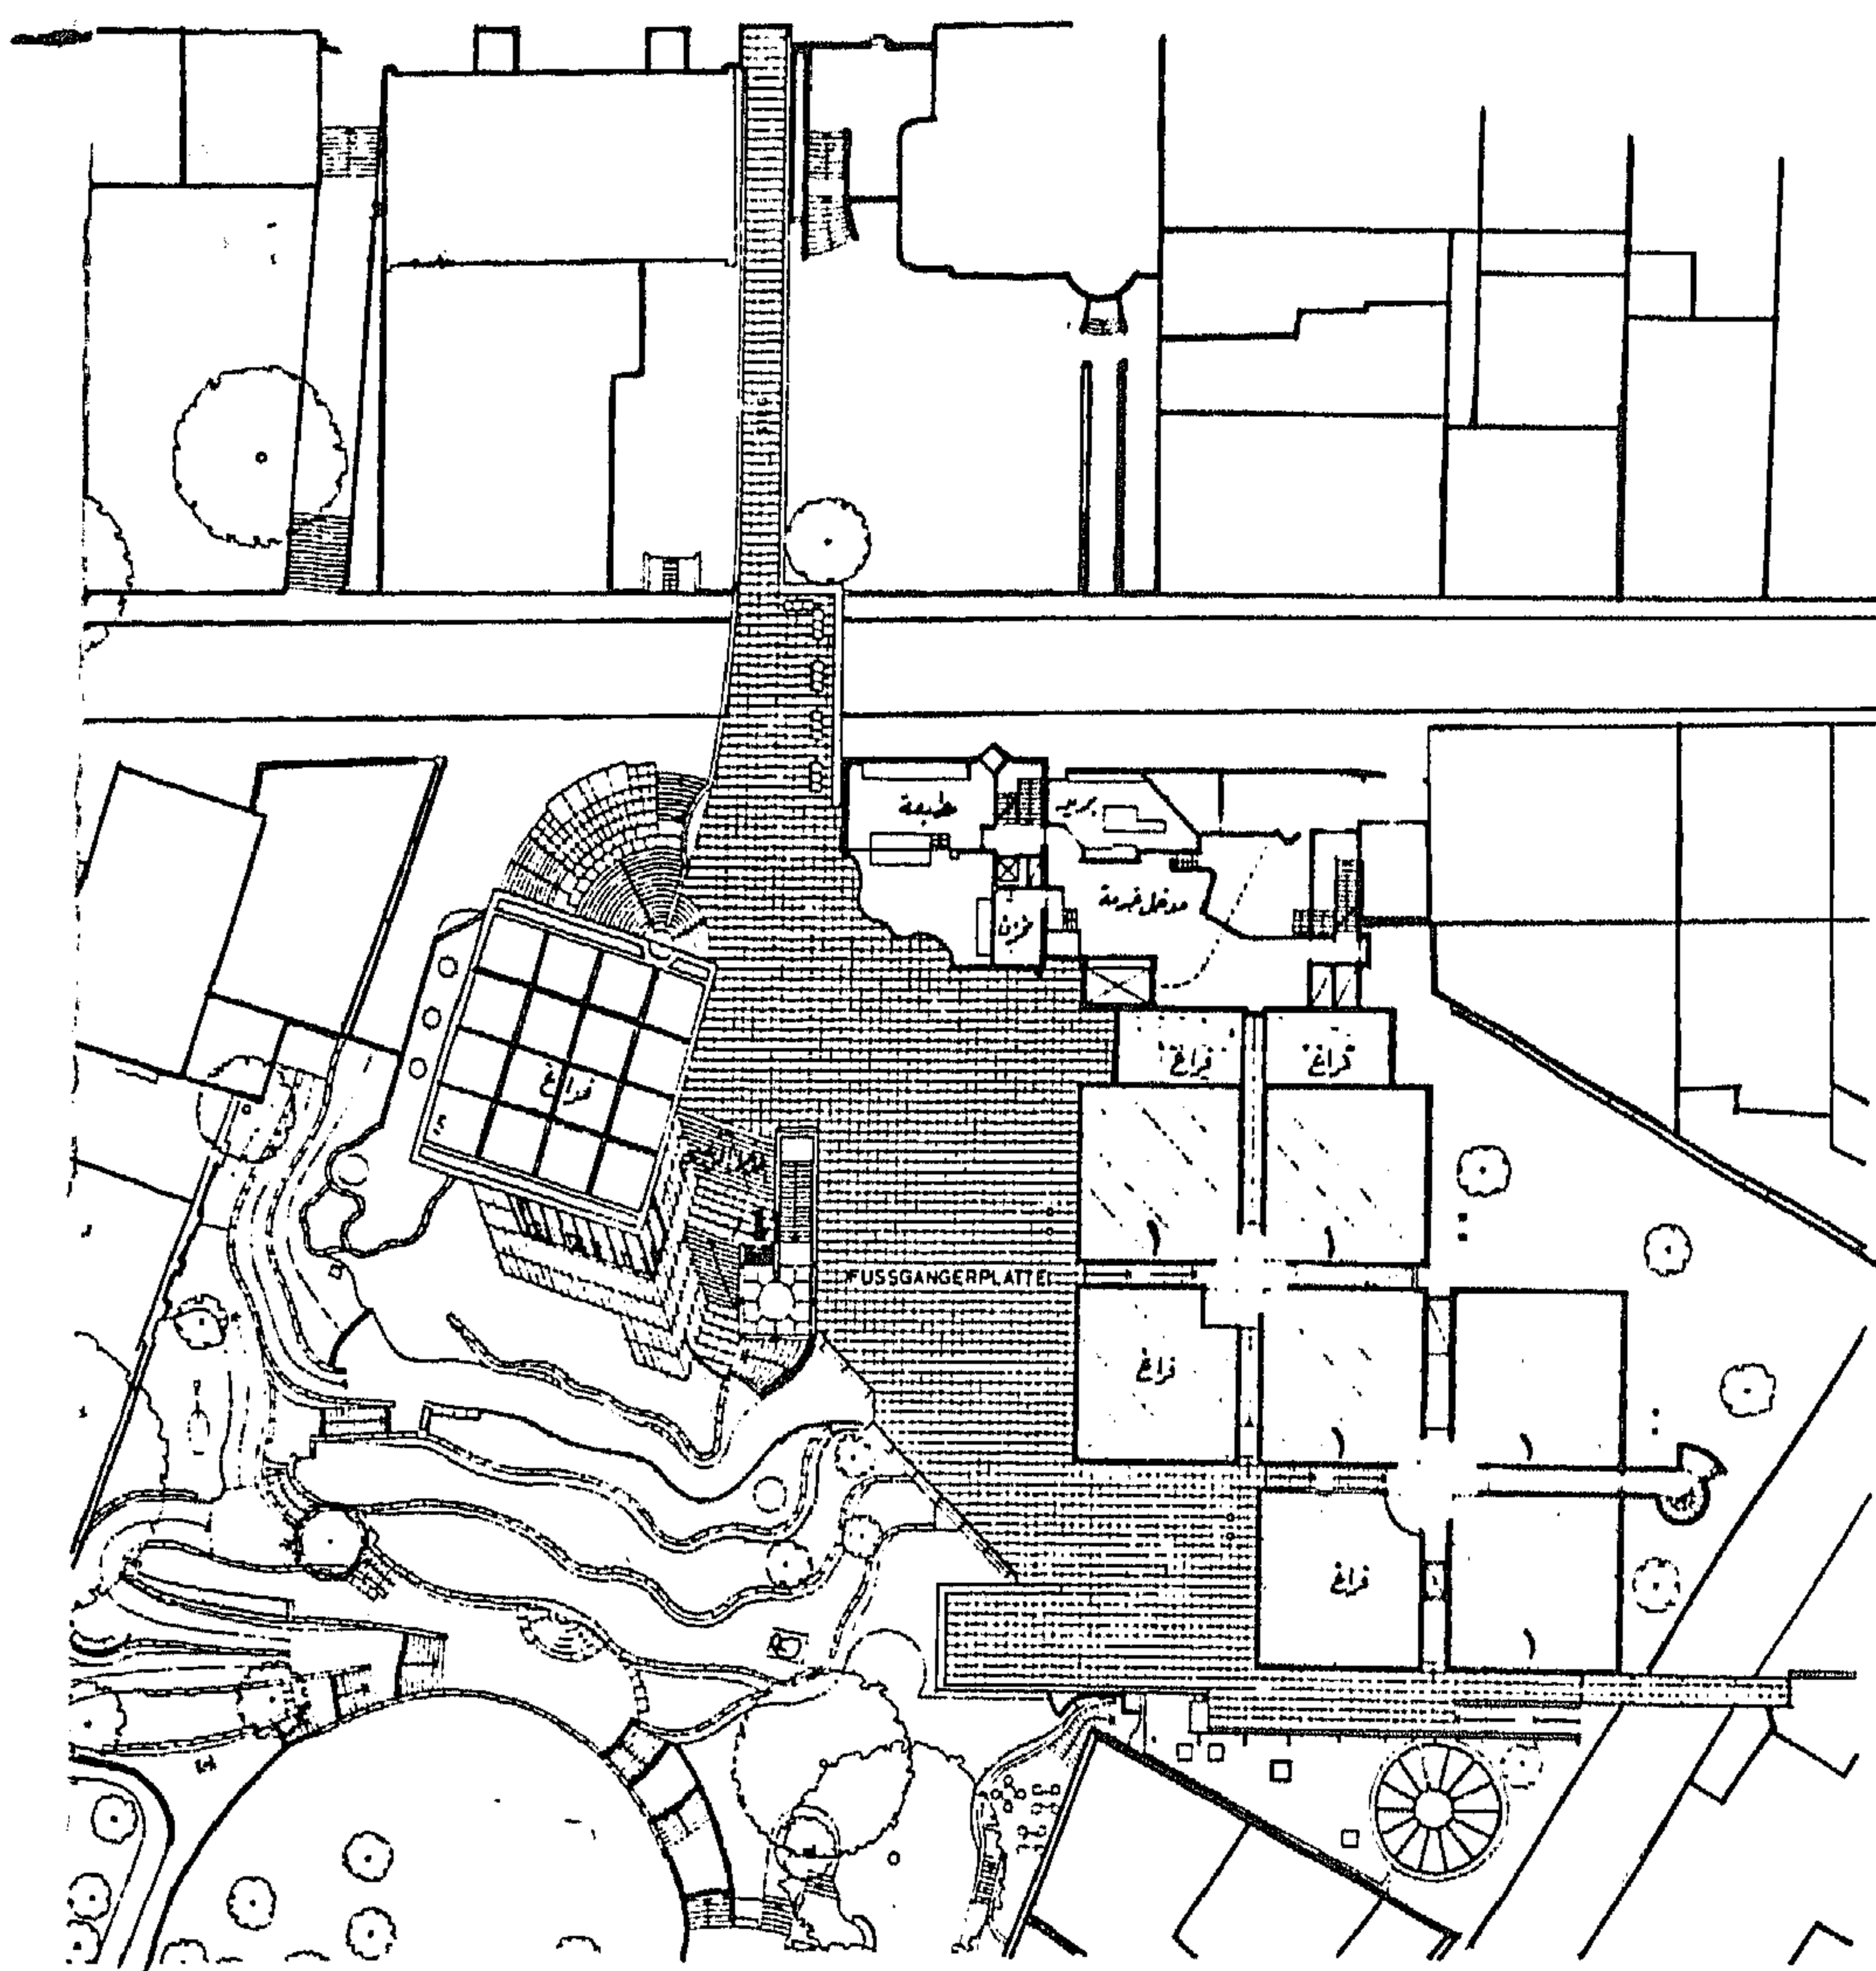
مسقط أفقي في مستوى الشارع
